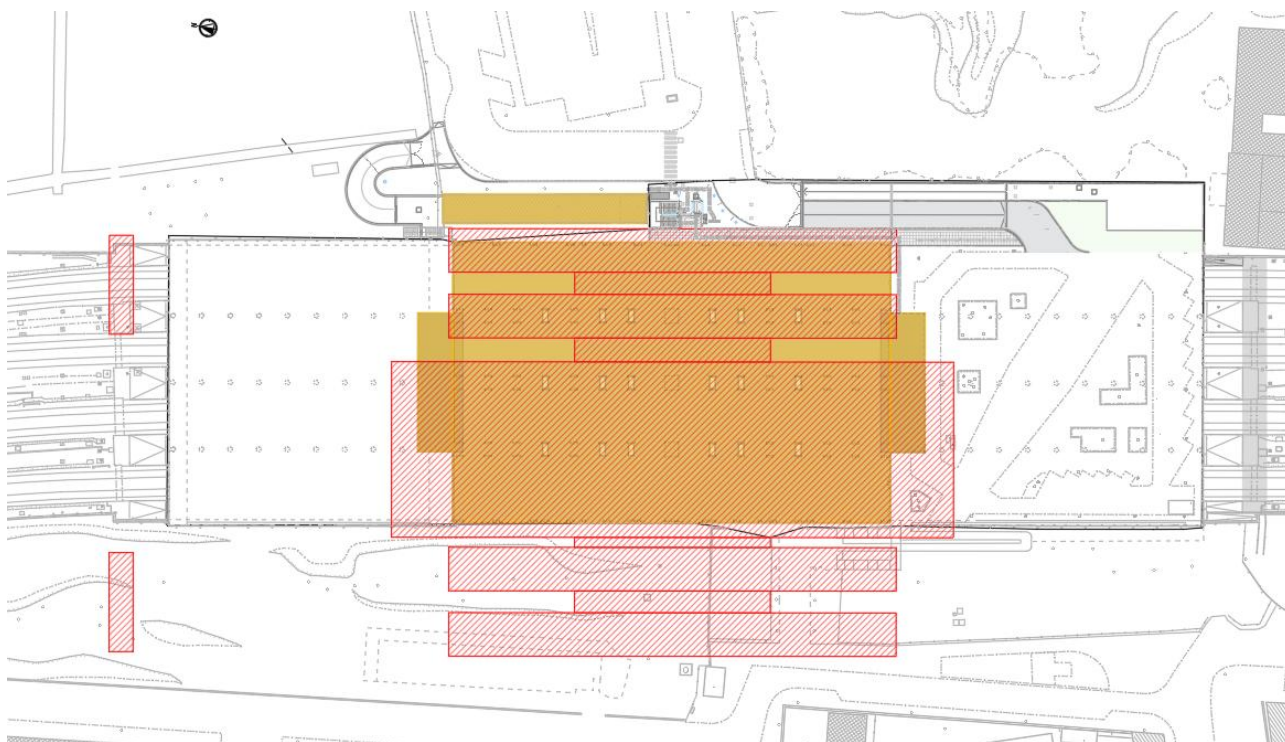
Planimetria demolizioni Piano Coperture Stazione di Bovisa (demolizioni in giallo)
